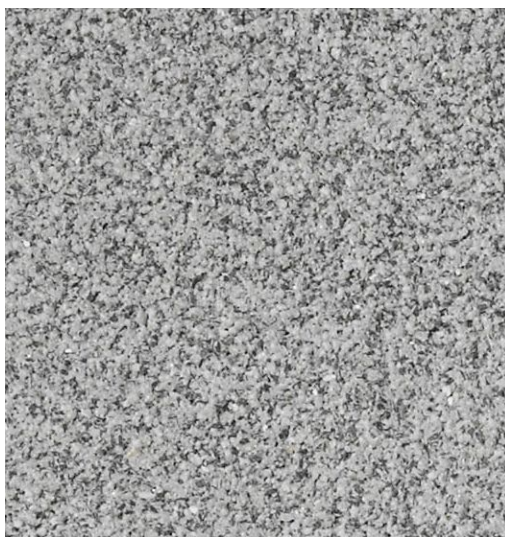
Autobloccante in cemento con finitura in quarzite – Bianco Mix- Pavimentazione Piazza
